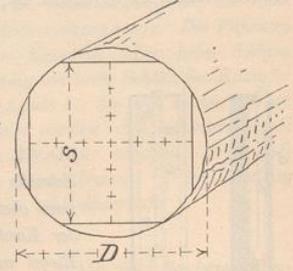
Beschlagen. Der quadratische Beschlag eines Bauholzes mit Baumkante wird ermittelt durch:
